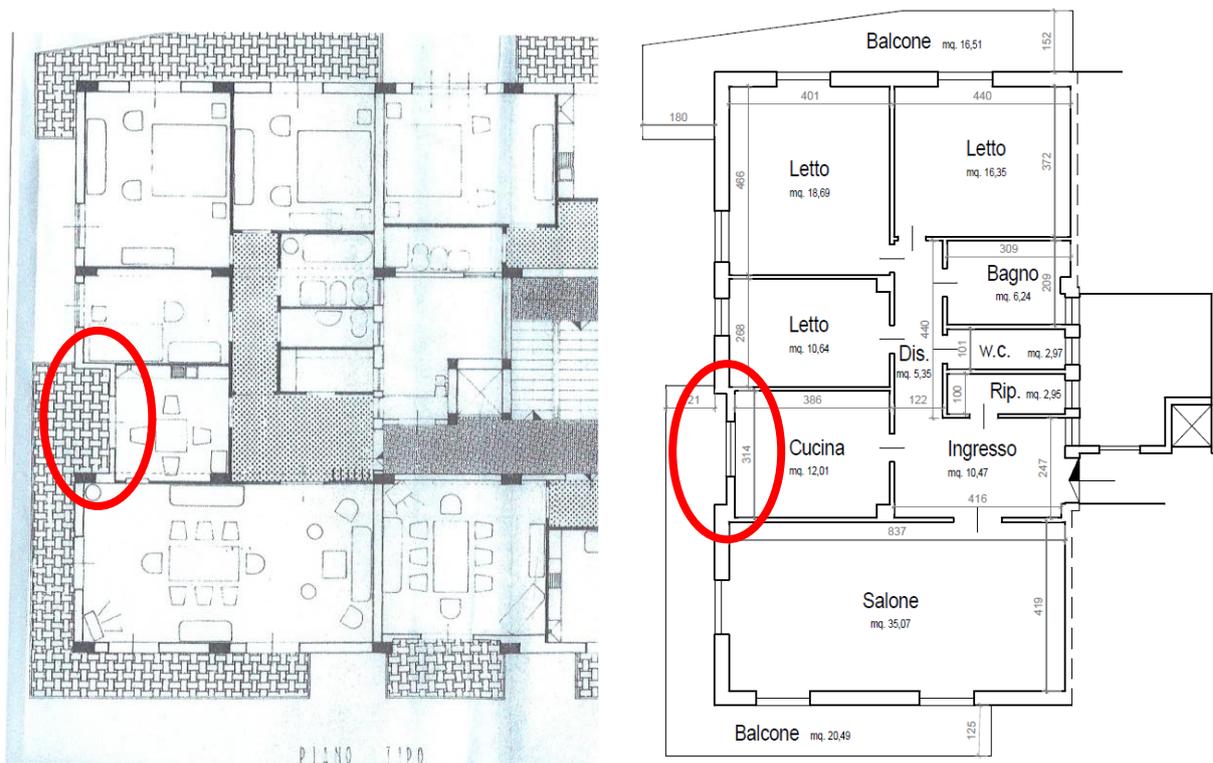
Confronto tra la planimetria di progetto e quella dello stato di fatto.
